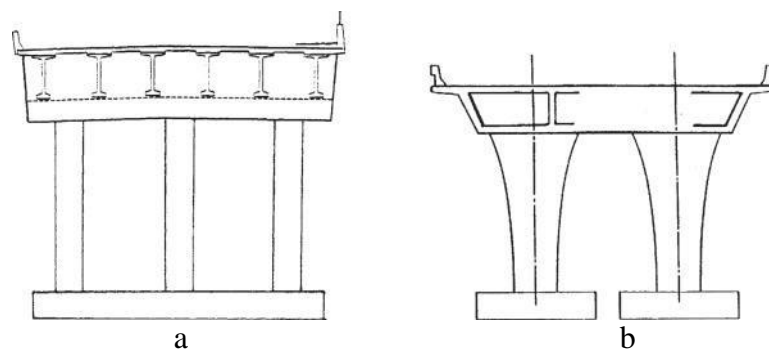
Bagian pilar tampak samping (Chen, dkk., 2000).
